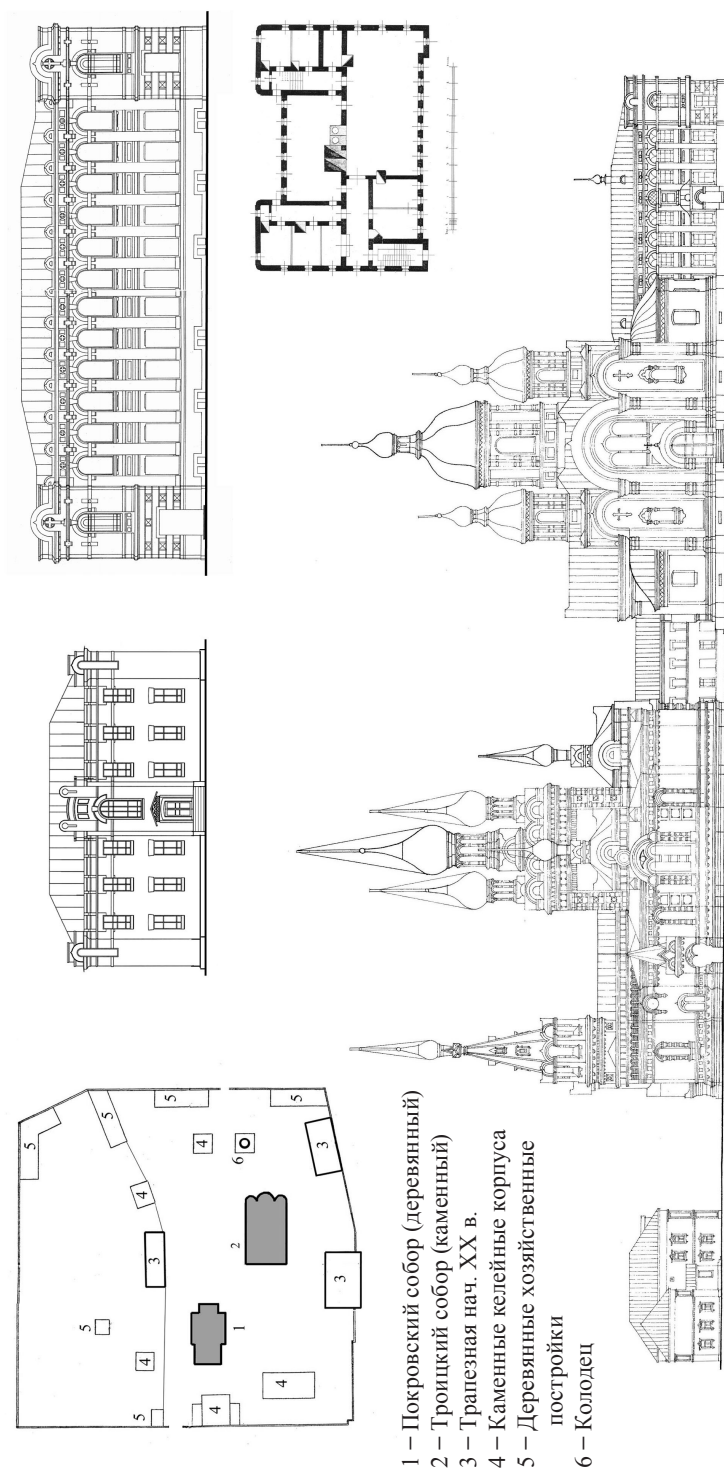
Покровский собор. Проект 1900 г. Фасад, план (вверху).
